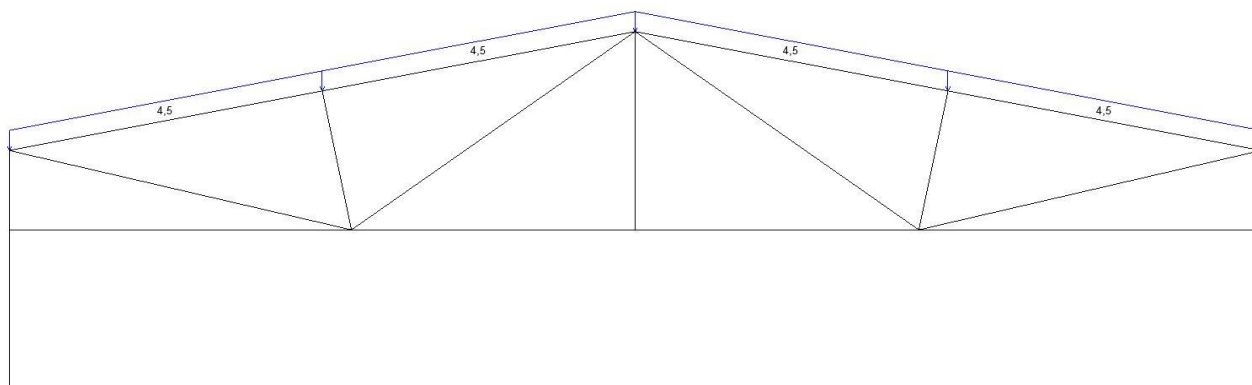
Снеговая нагрузка на ферму, вариант 1
